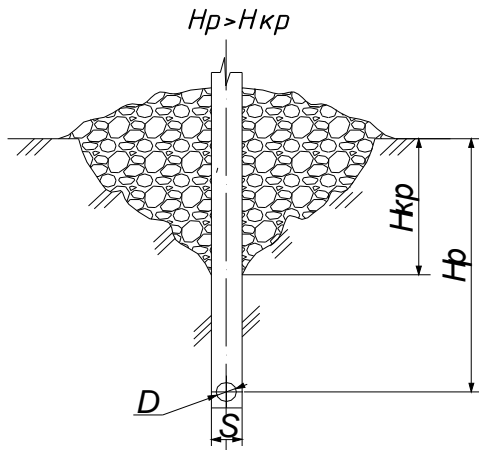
Характер разрушения грунта при укладке трубопровода до 150-200 мм
